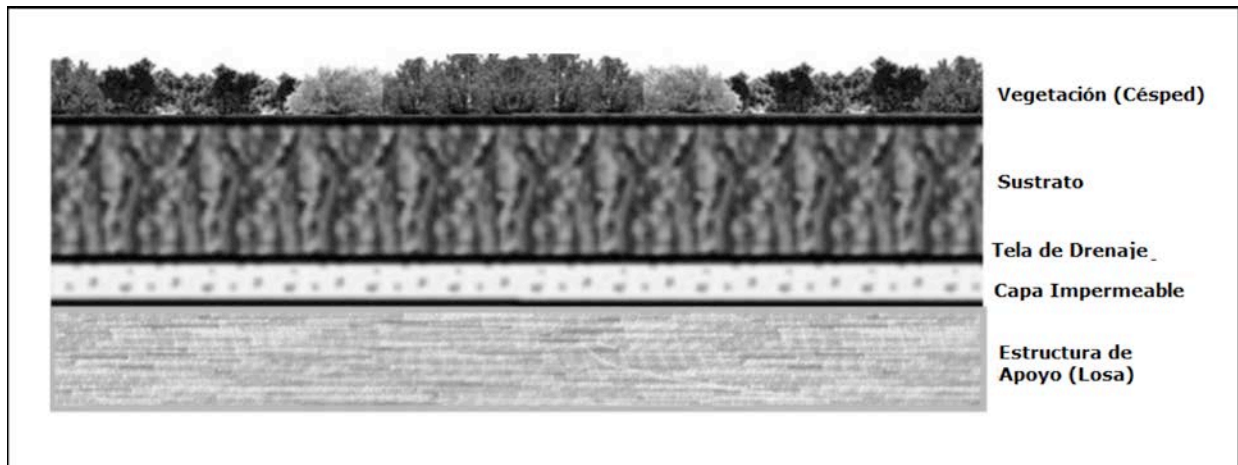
Perfil de un techo verde. Fuente: Elaboración propia
